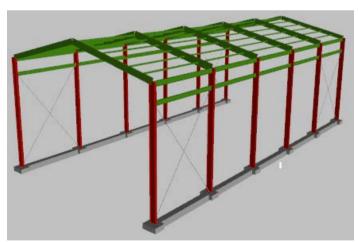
D de la estructura y cimentación del henil con el programa CYPE 3D
